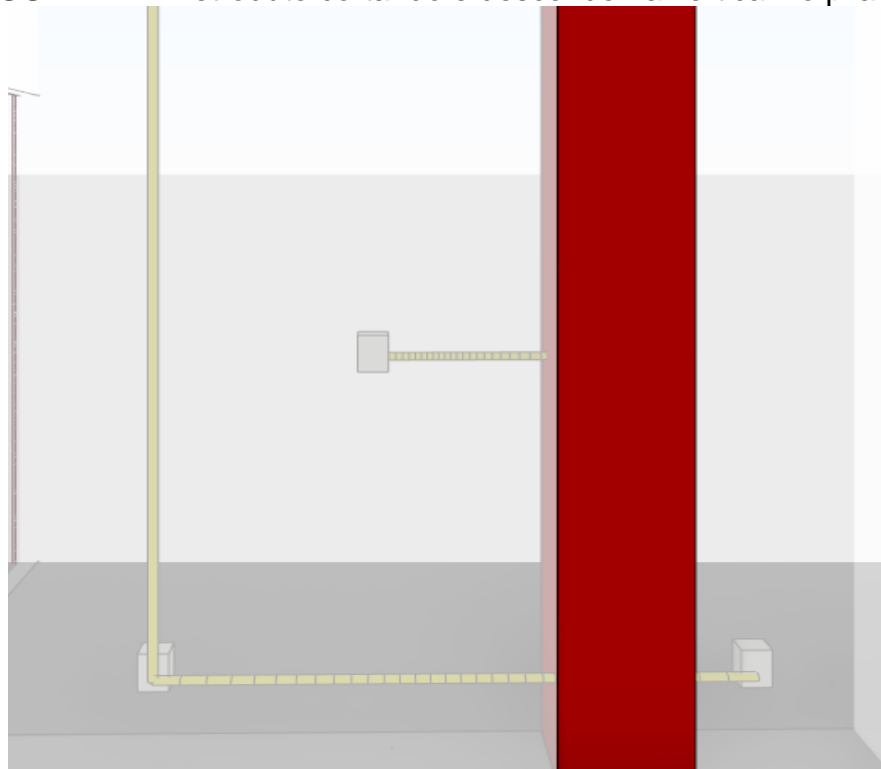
Resolução da coluna de ventilação atravessando o bloco B3
